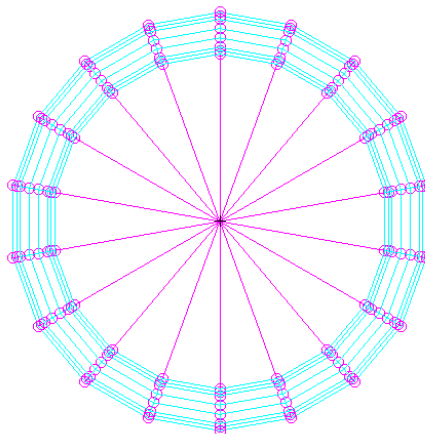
Ligação rígida entre centro e elementos da seção transversal
